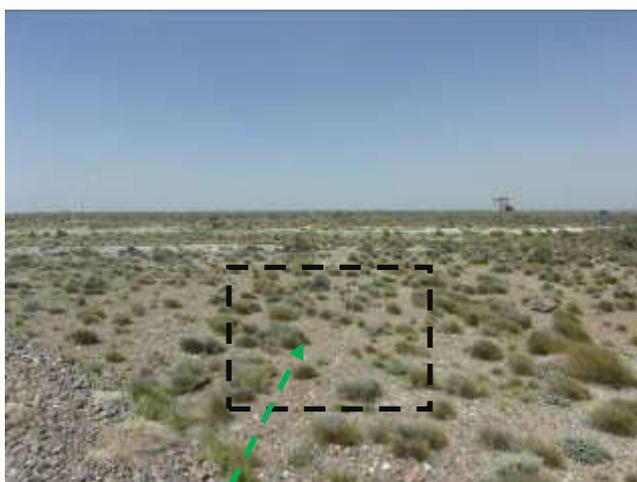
Emplazamiento de acueducto por margen interno de camino (Verde) e interferencia con picada existente (Marrón). Foto en dirección N.
